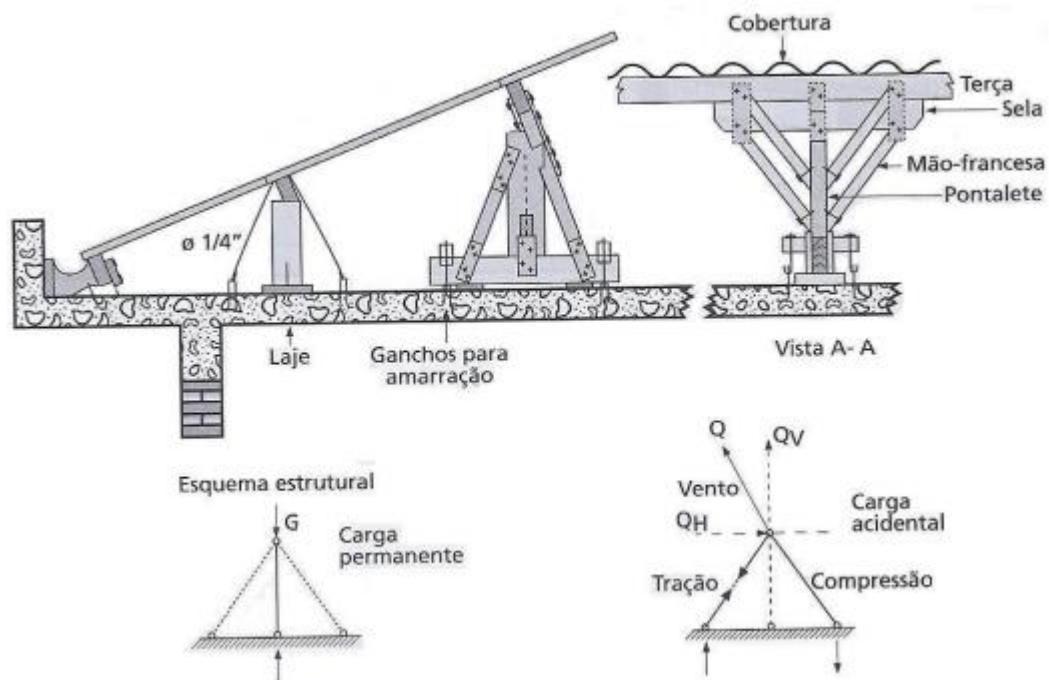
Terças apoiadas sobre pontaletes fixos na laje e contraventamento com cabo de aço.
